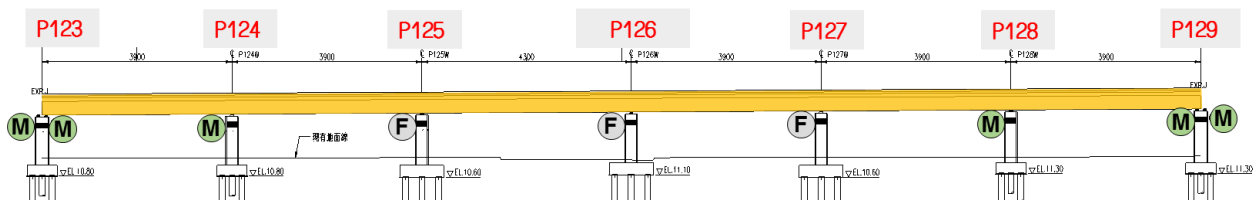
國 10 高架(二)橋第 15 單元立面配置圖
